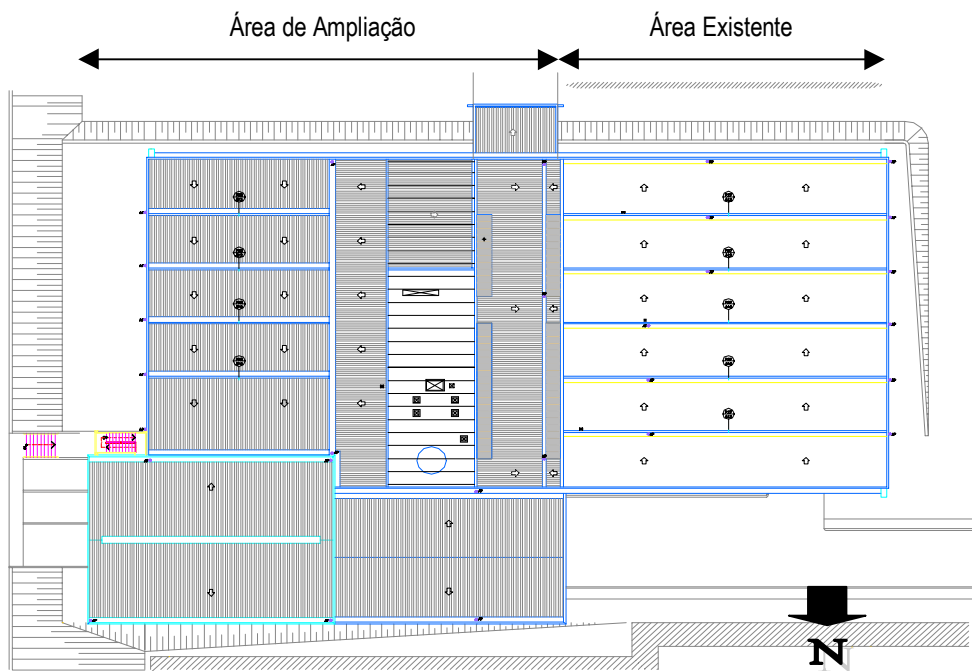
Planta de implantação do Laboratório Poli (s/ escala)
